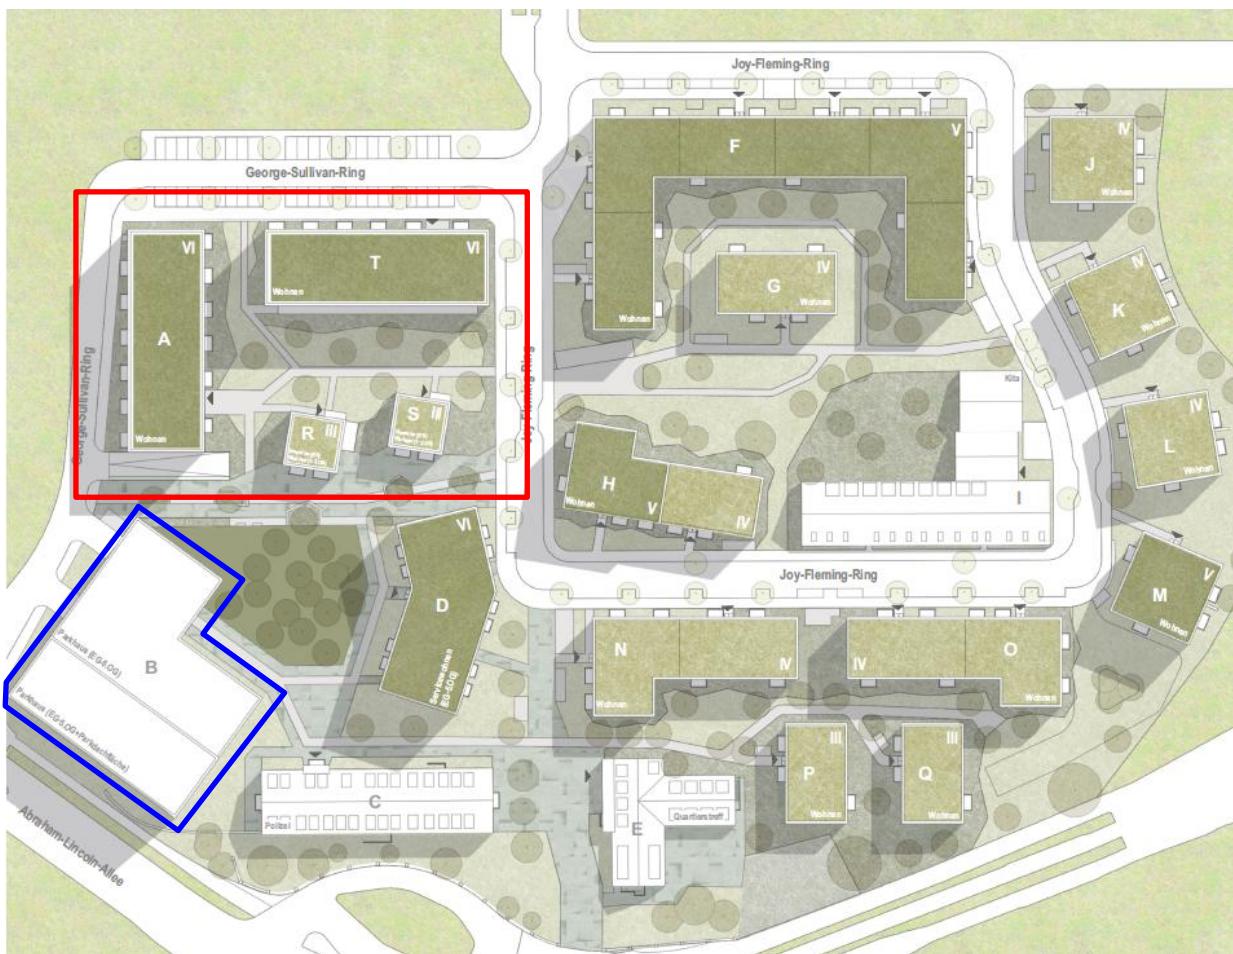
Übersichtsplan über das Plangebiet mit aktueller Planung - städtebaulicher Entwurf; farbige Markierungen siehe Text /3/
